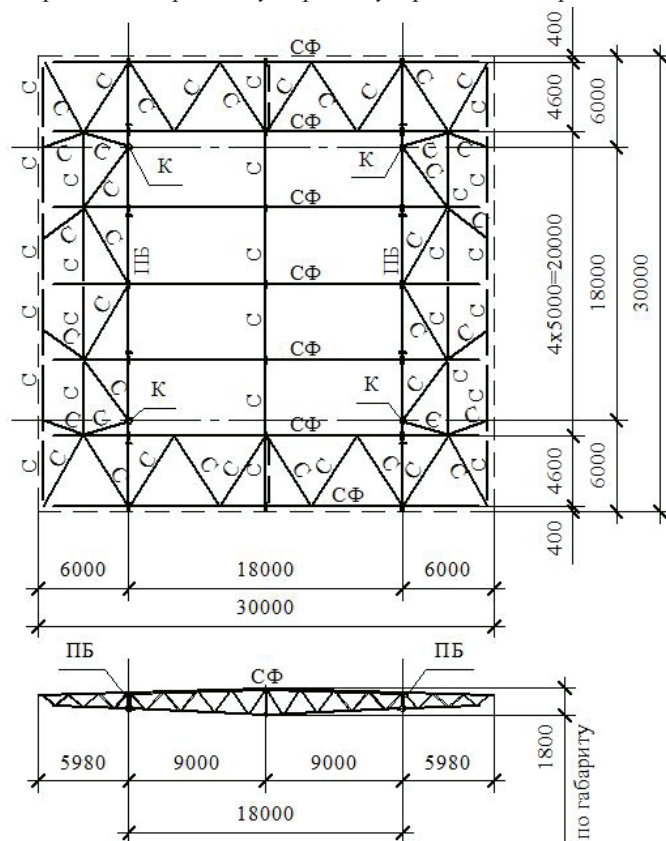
Схема покрытия с подстропильными балками и стропильными фермами (Вариант 3).
